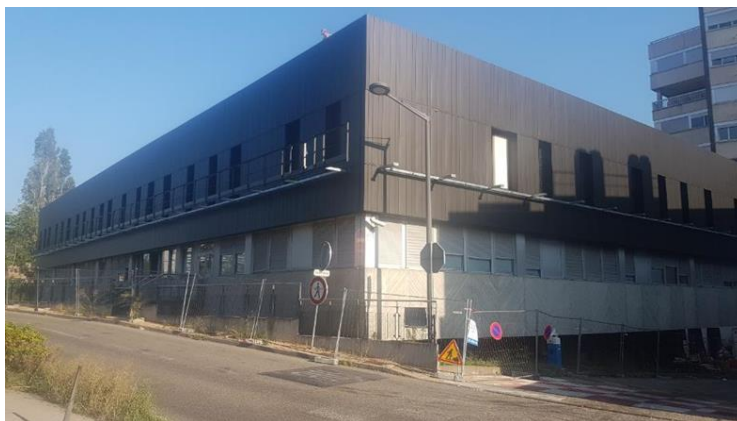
Photo du chantier du B16 au groupement hôpitaux Est Lyon
